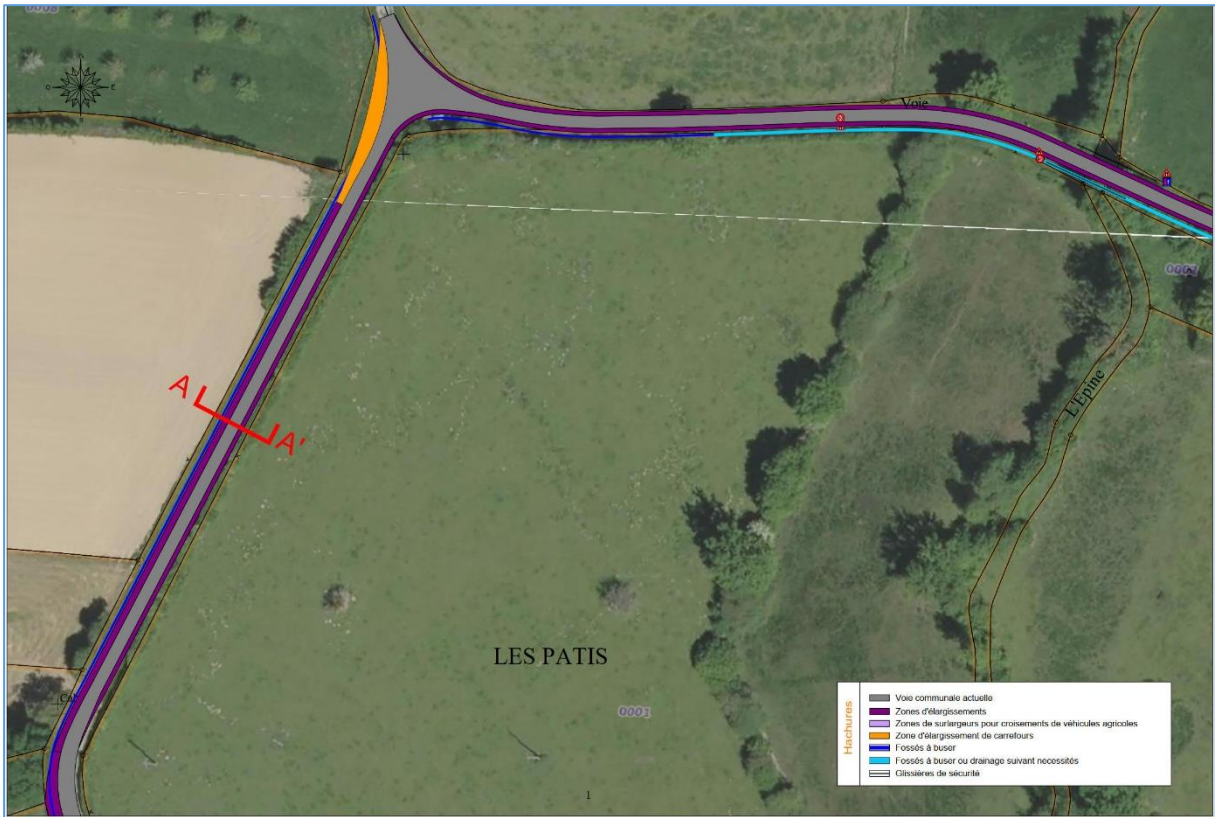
Aménagement routier de la RD 865 - Plan n°1
